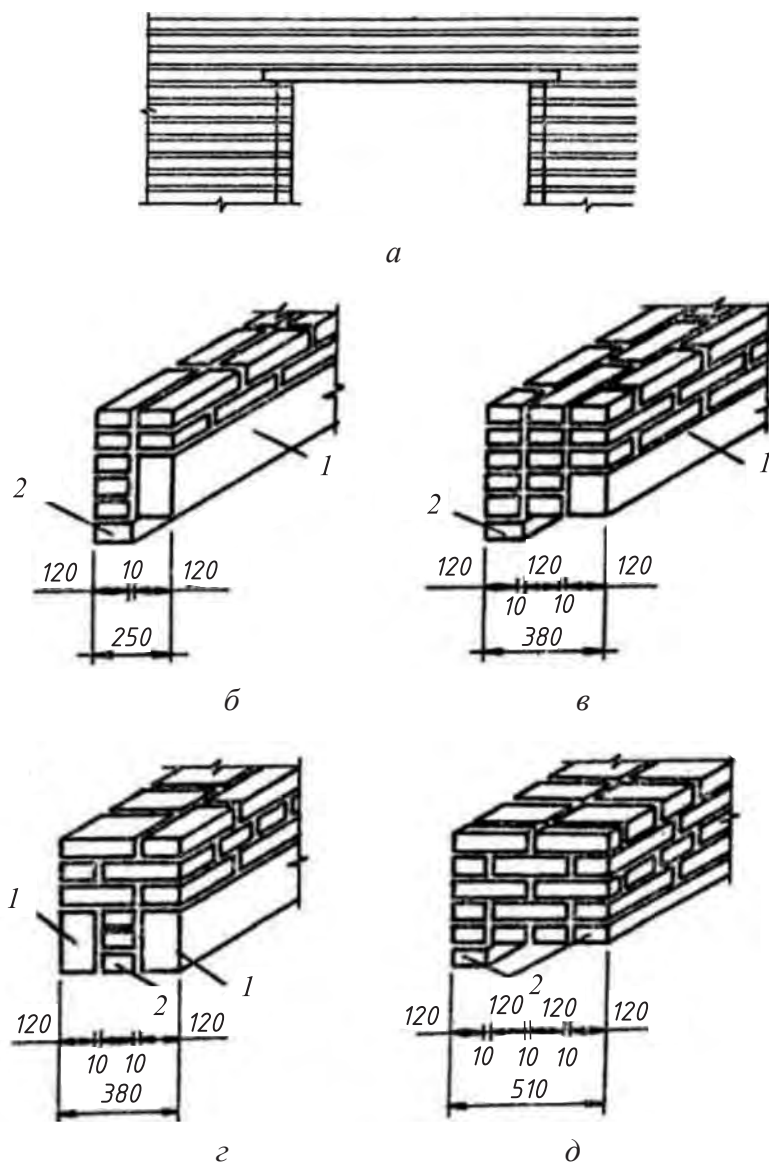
Железобетонные перемычки (размеры в мм): *a* — общий вид; *б, в* — наружные стены толщиной 25 и 38 см; *г* — наружная и внутренняя стена толщиной 38 см; *д* — наружная стена толщиной 51 см; *1* — несущая перемычка; *2* — ненесущая перемычка
